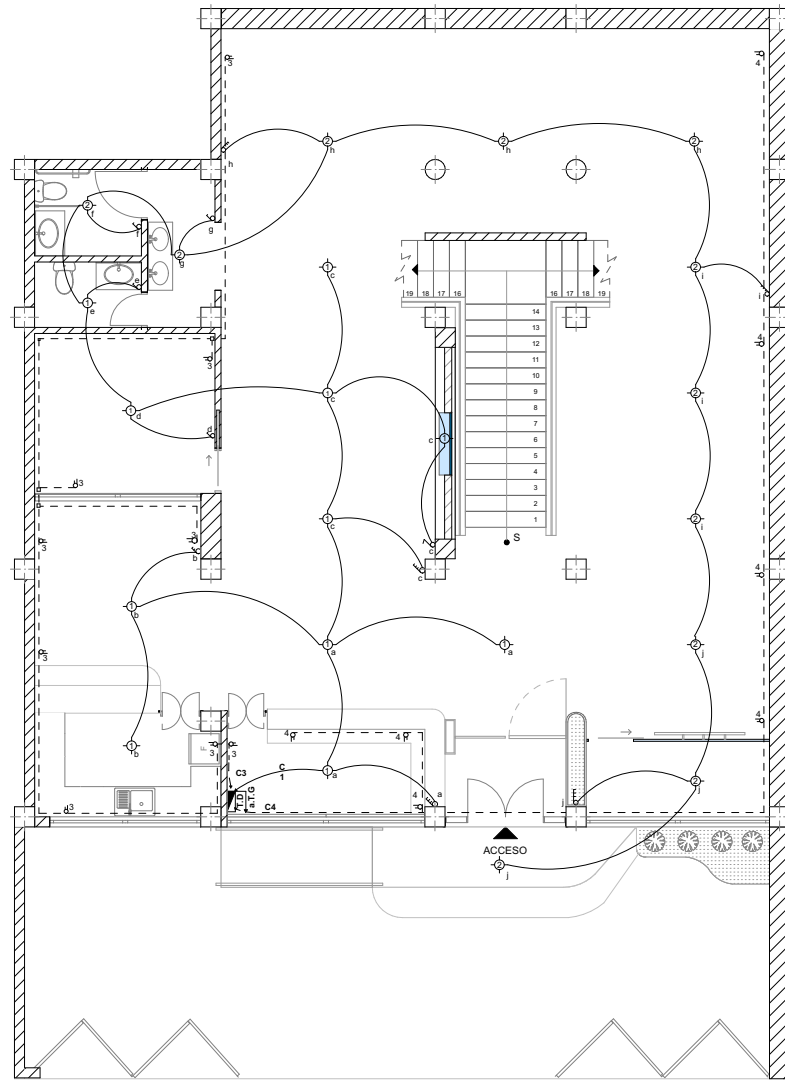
Planimetría de la propuesta del gimnasio Kratos gym.
